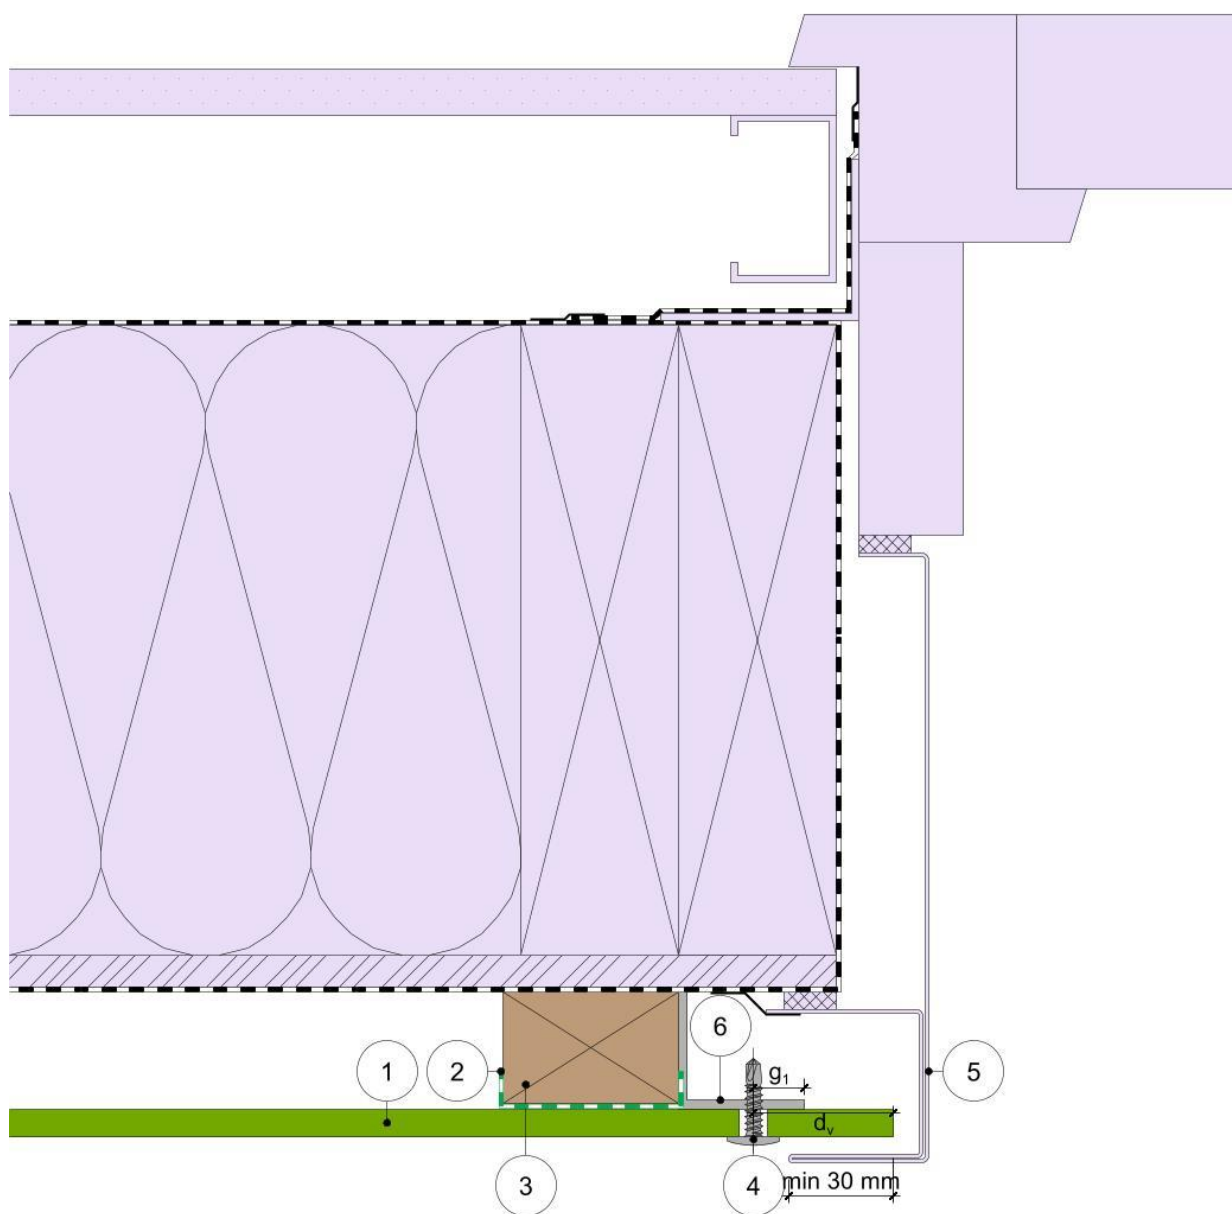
Exemple de mise en œuvre des panneaux fibres-ciments en tableau de baie – coupe horizontale
